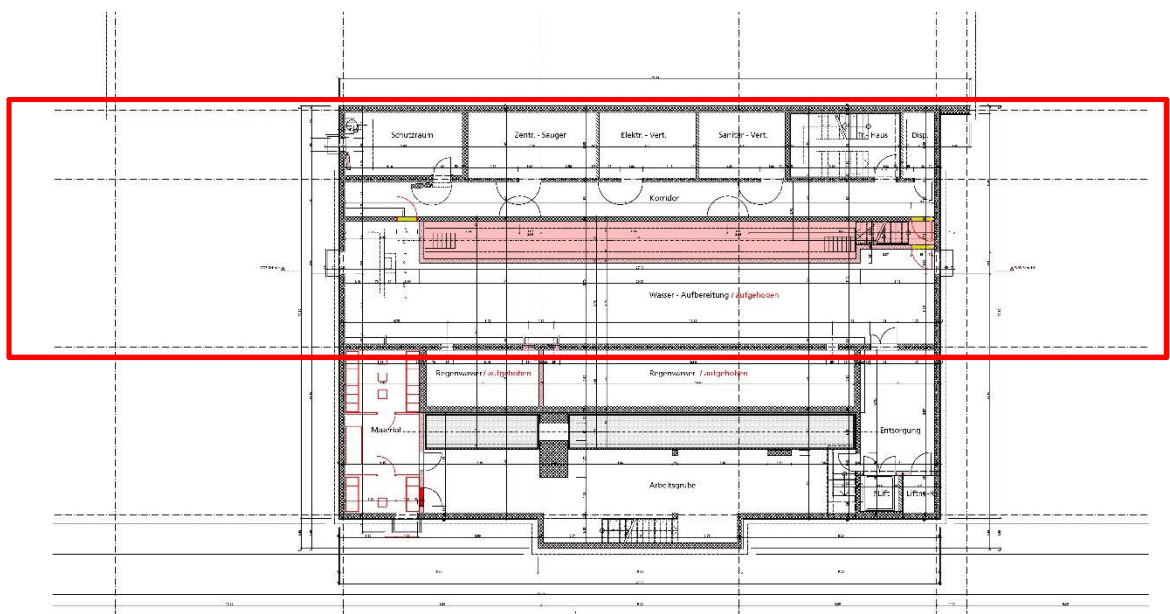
Grundrisslayout Prüfhalle 2, Untergeschoss
